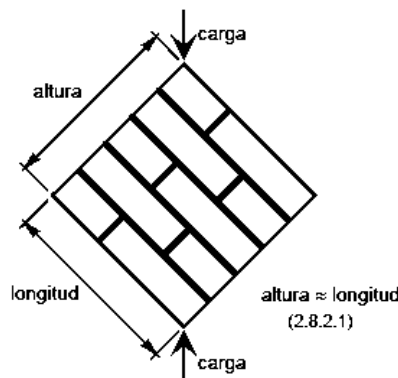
Murete para prueba en compresión, (NTC-M, 2004).
